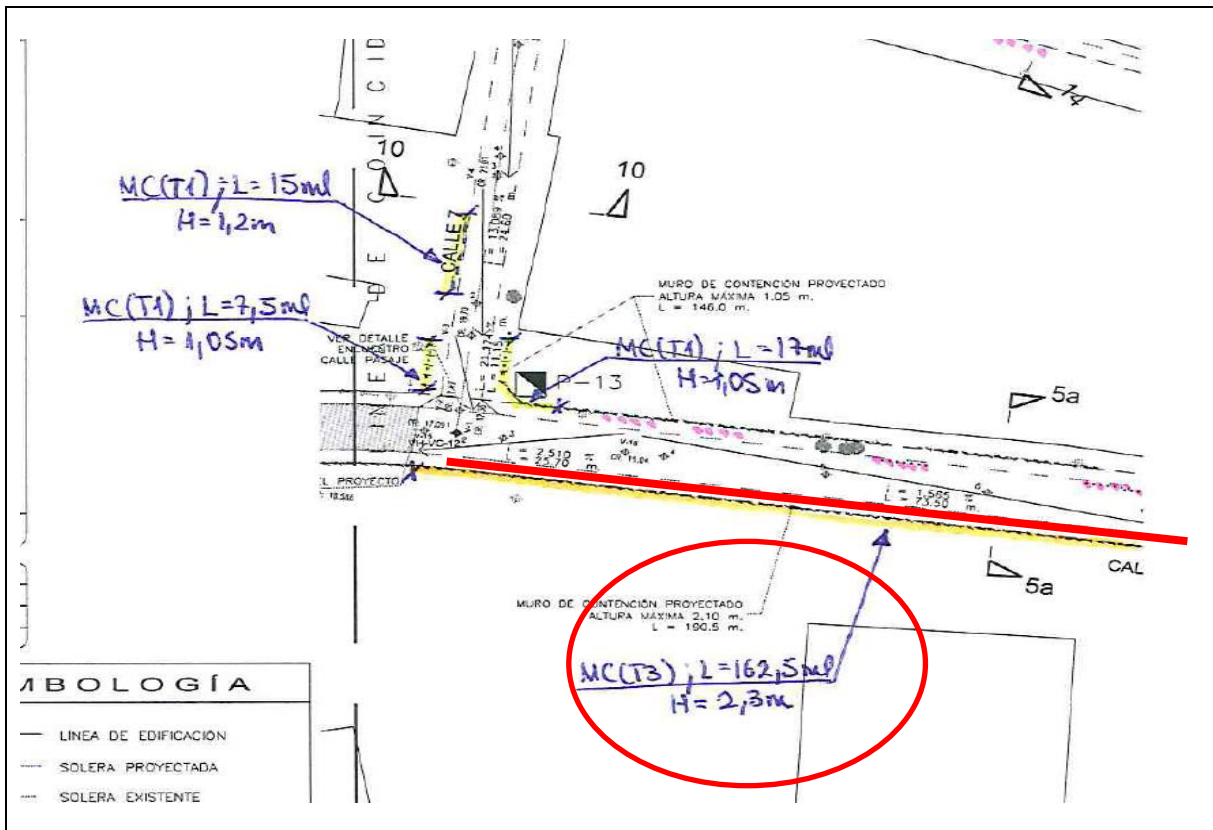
Detalle de muro hormigón armado G30,  $0,4m < h < 1,2m$ , de longitud de 162,5 m y de altura 2,3 m según plano modificado en terreno.
